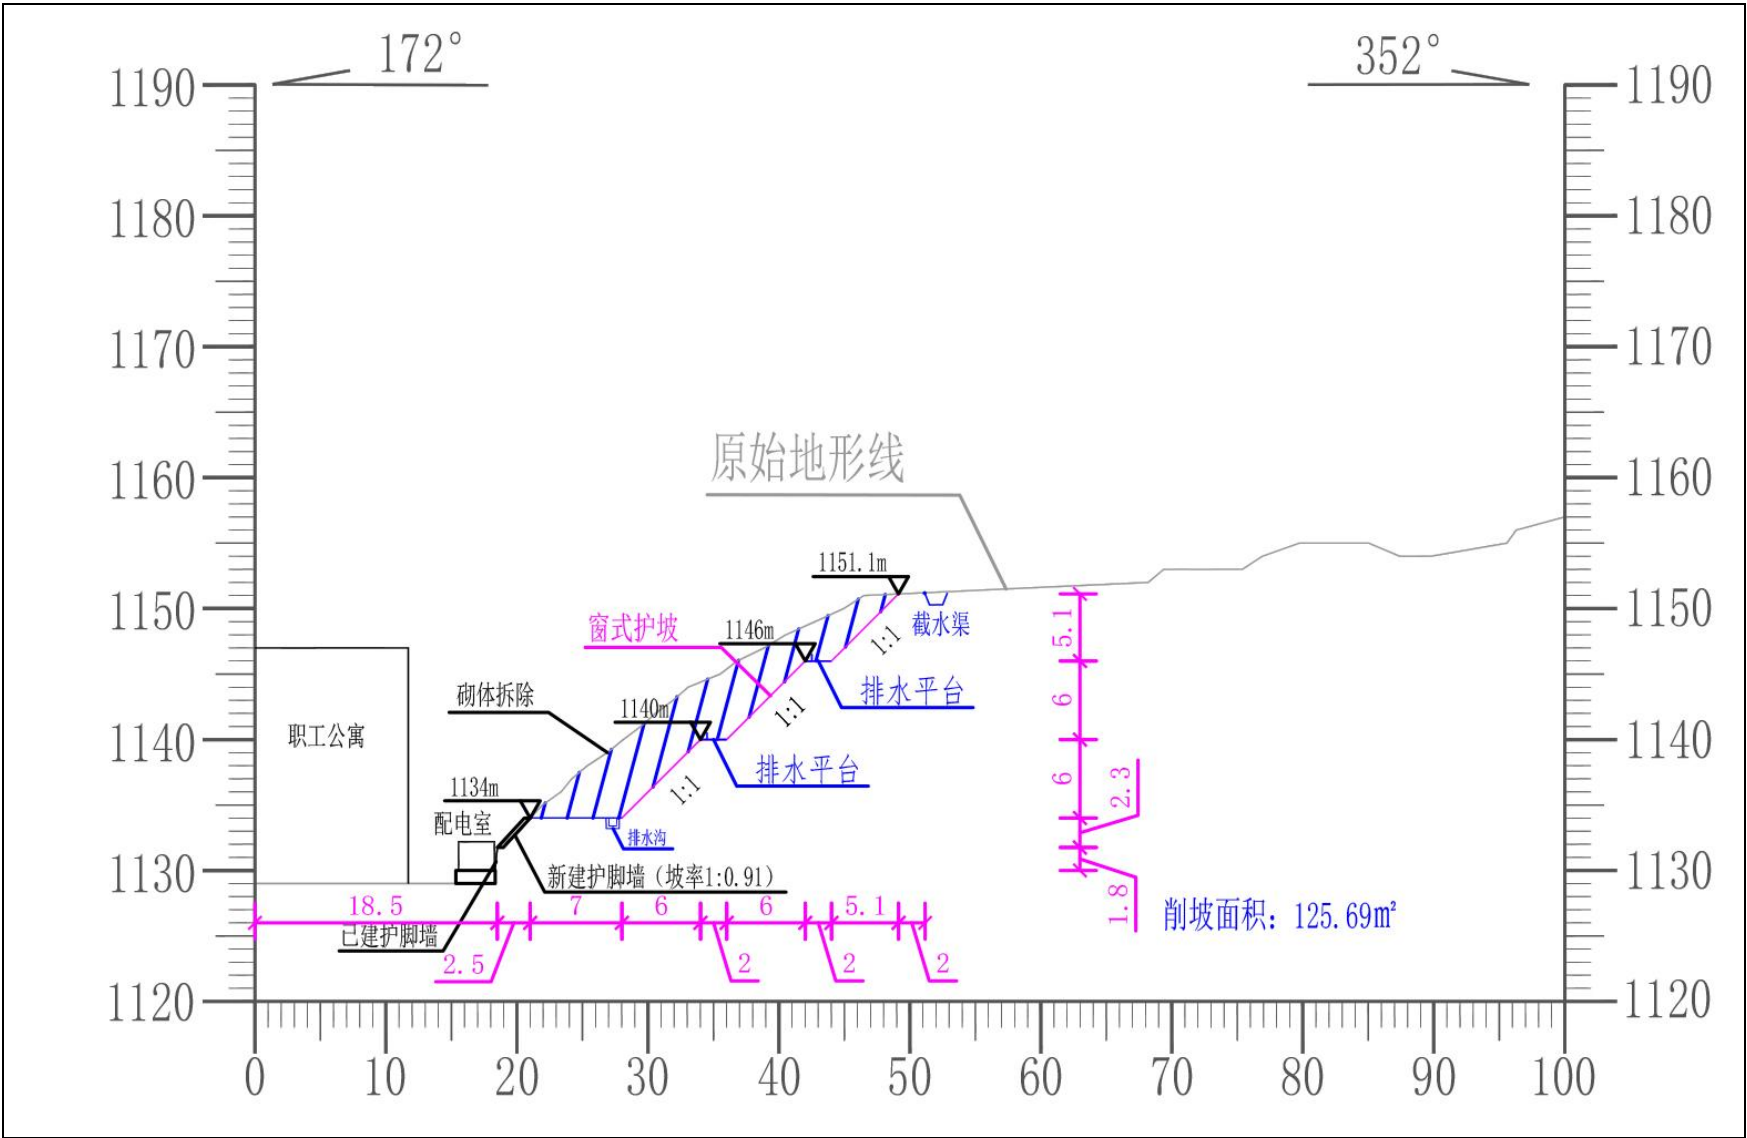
不稳定斜坡 BP1 治理工程平面设计图（6-6' 剖面）
